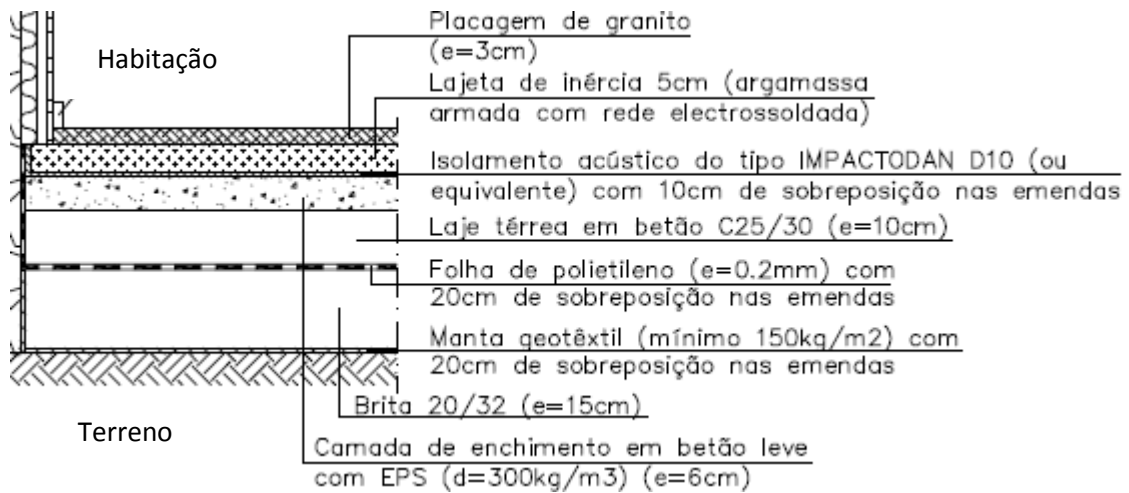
Pormenor construtivo do piso térreo [19]
